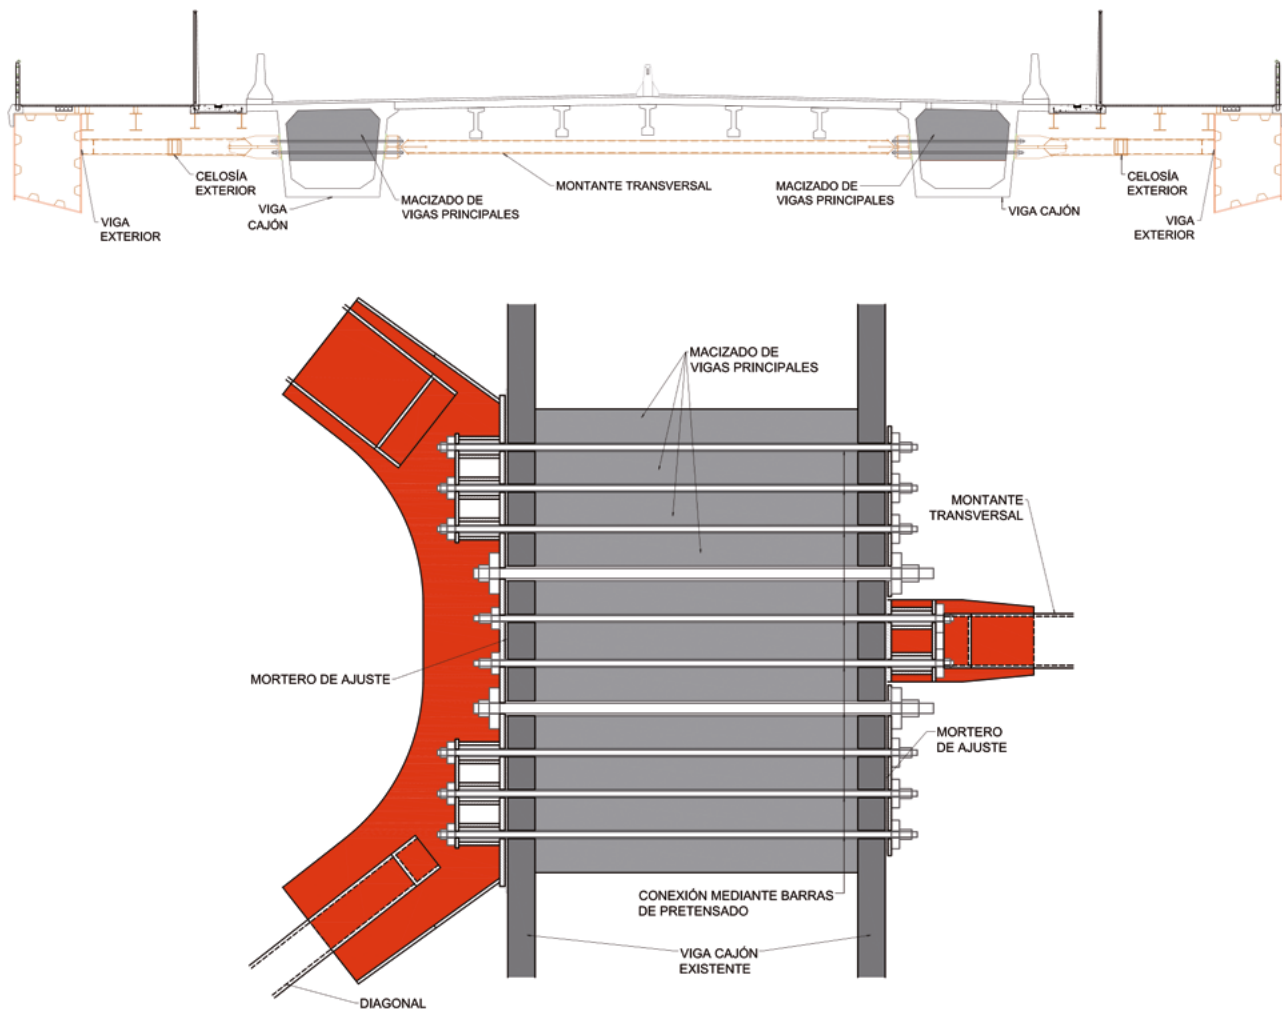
Arriba, sección transversal tipo del puente del Centenario tras la sustitución de tirantes. Abajo, detalle en planta de la conexión celosía-cajón de hormigón prefabricado existente resuelta mediante barras pretensadas de los montantes transversales y celosía exterior.
